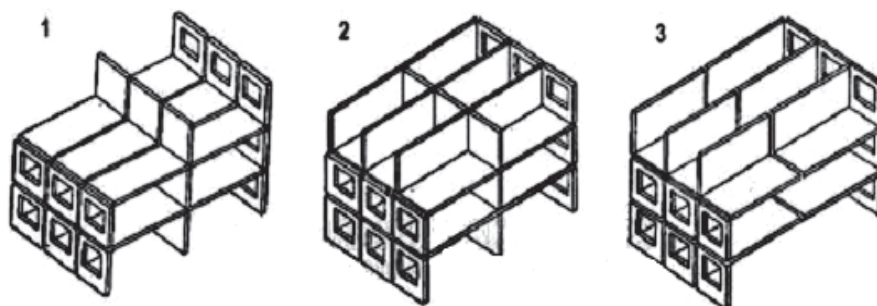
Конструктивные схемы бескаркасных крупнопанельных жилых домов.
